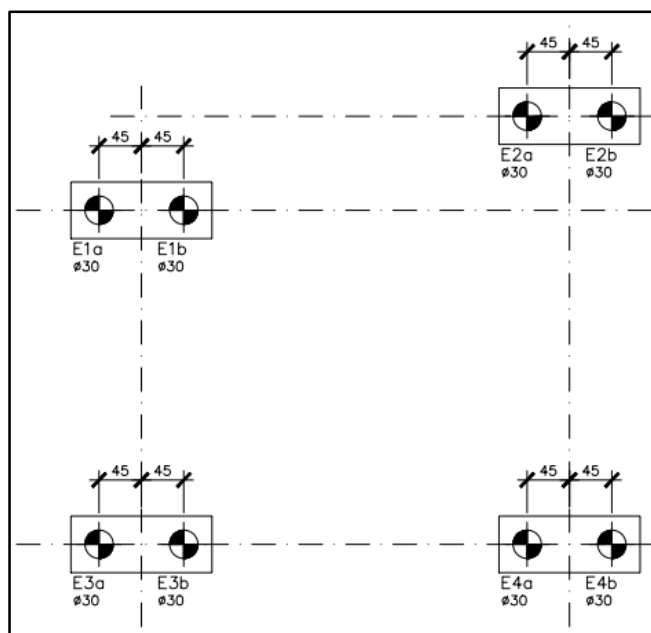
Planta de locação blocos de fundação – Castelo D'água
